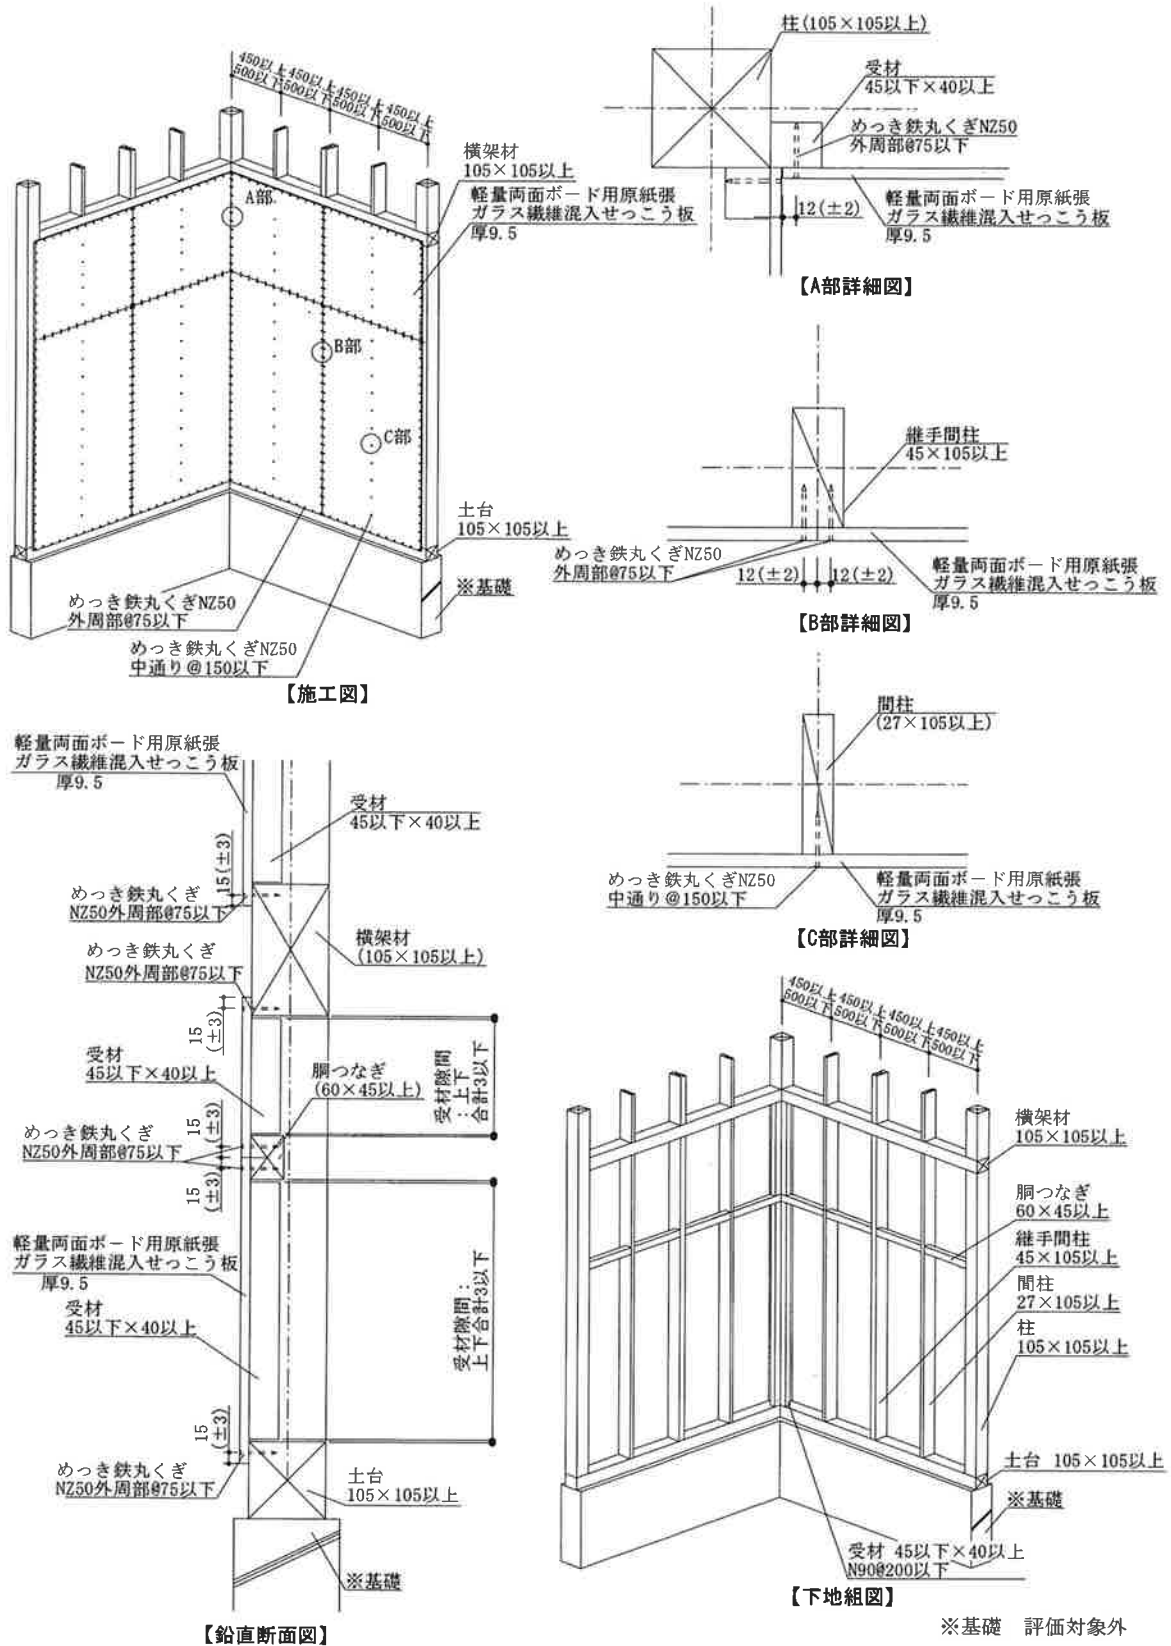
施工詳細図：縦継ぎ張りの場合 (寸法単位：mm)
